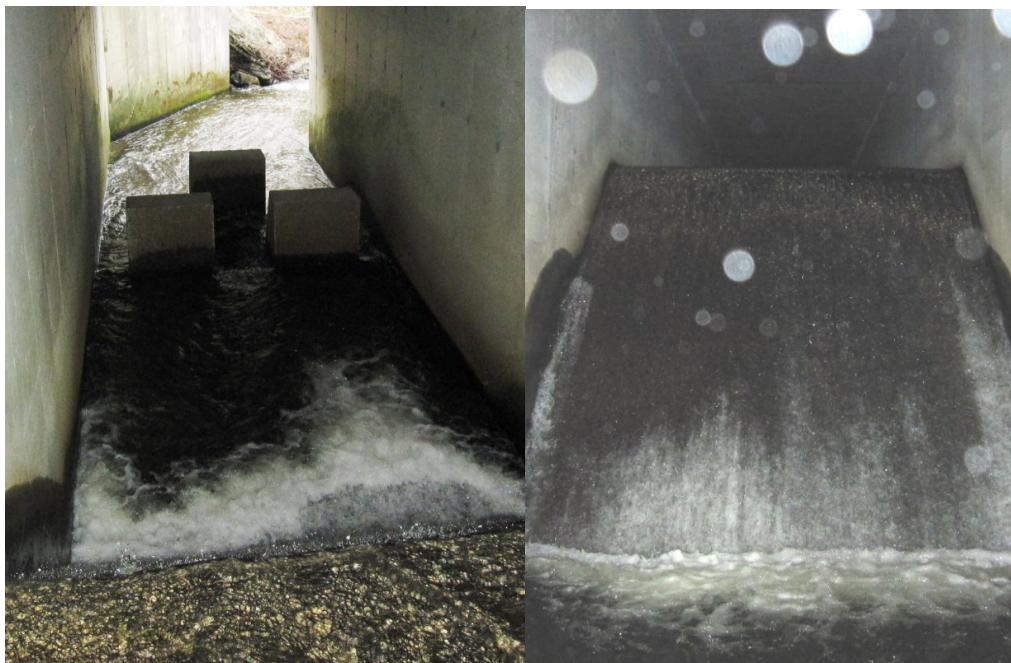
Kulvertutløp nedstrøms Fv 950 (Nr. 87) i Vikhammerelva. Foto: Morten Bergan.
